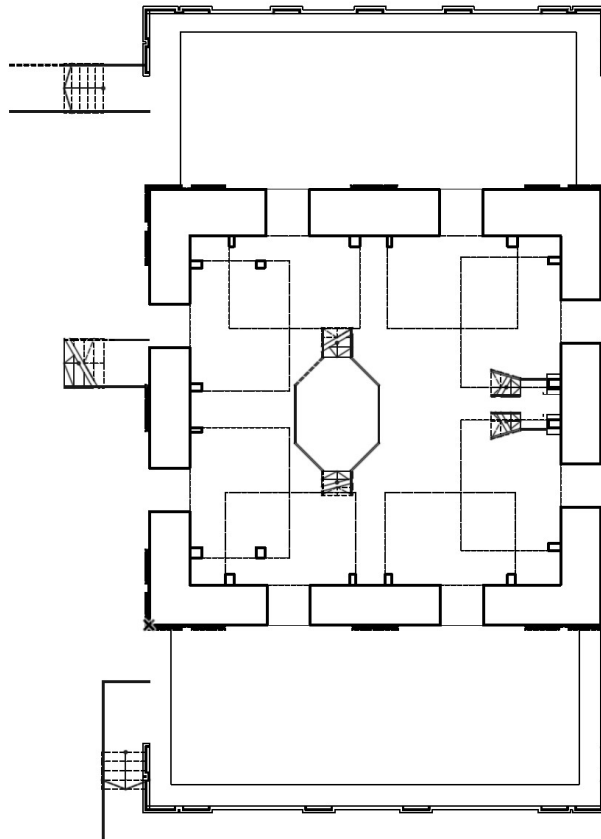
Zamosc_Grundriss_Obergeschoss.png
